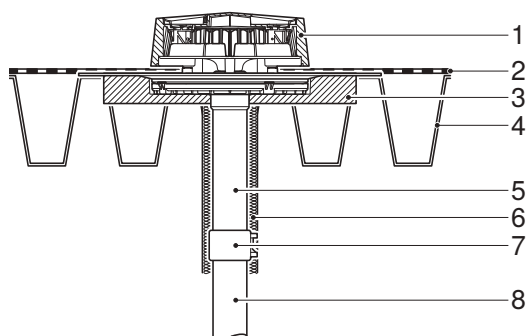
Montage dans toiture en bac d'acier non isolée avec bavette d'étanchéité Geberit Pluvia
